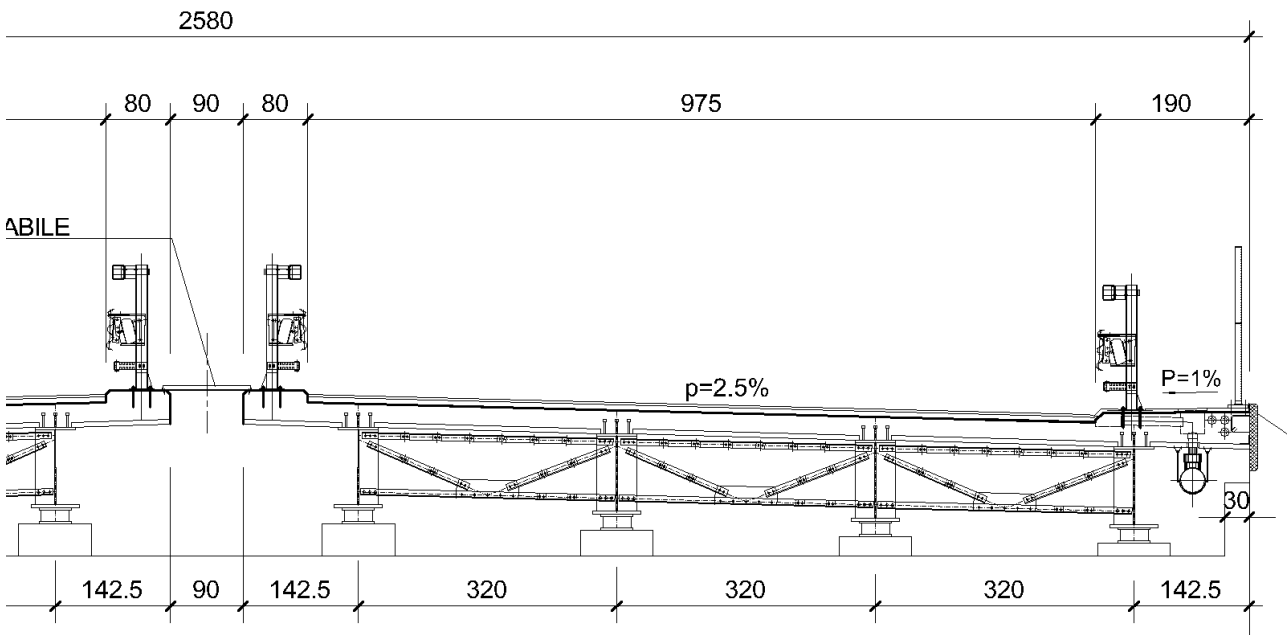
SEZIONE TIPICA IMPALCATO (SU SPALLA)
